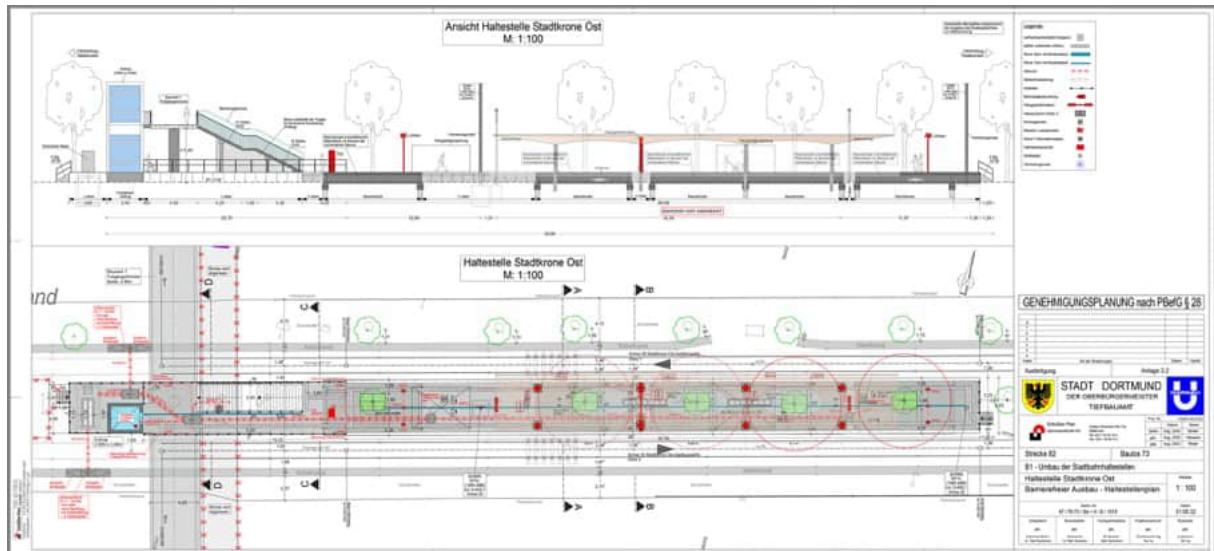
Vorgelegter Haltestellenplan mit acht markierten Untersuchungspunkten (vom 09.02.2024).
